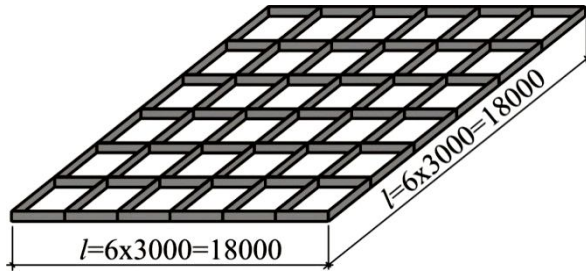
Схема системы перекрестных балок на квадратном плане
